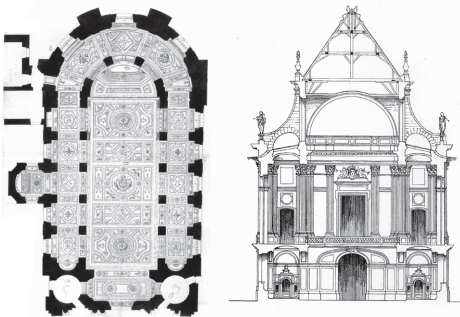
Plan du rez-de-chaussée et coupe de la Chapelle royale. Un déambulatoire circulaire prolonge le bas-côté. Au-dessus d'eux des arcs-boutants dévient les poussées latérales de la voûte en berceau sur les piliers externes.
